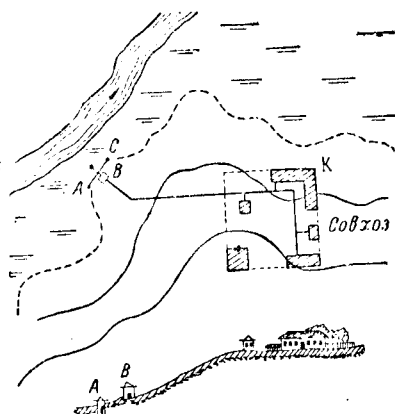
Схема напорного водопровода из фильтрационных речных вод: АС — сборная галерея, В — машинное здание, ВК — трубопровод.
